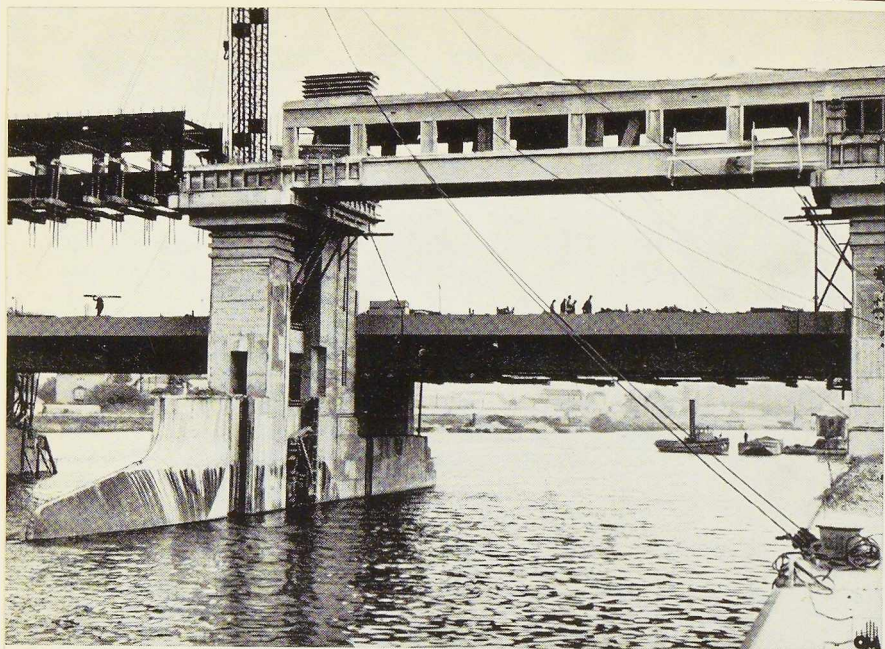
Vue amont du barrage. On voit le pont-route situé en aval et la construction de la passerelle de service en poutres Viereckel en acier enrobé.
